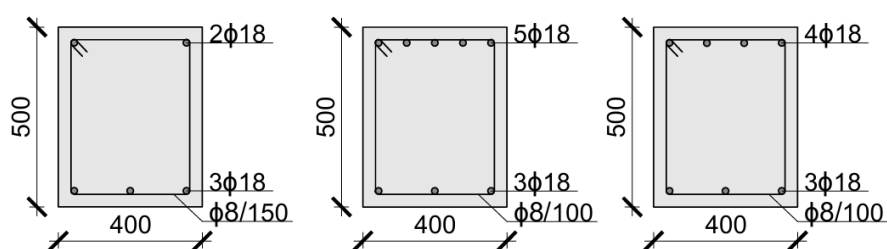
Sezioni trasversali tipo delle travi con dettaglio dell'armatura longitudinale e trasversale – sezioni 2, 3 e 4 (quote espresse in mm).
